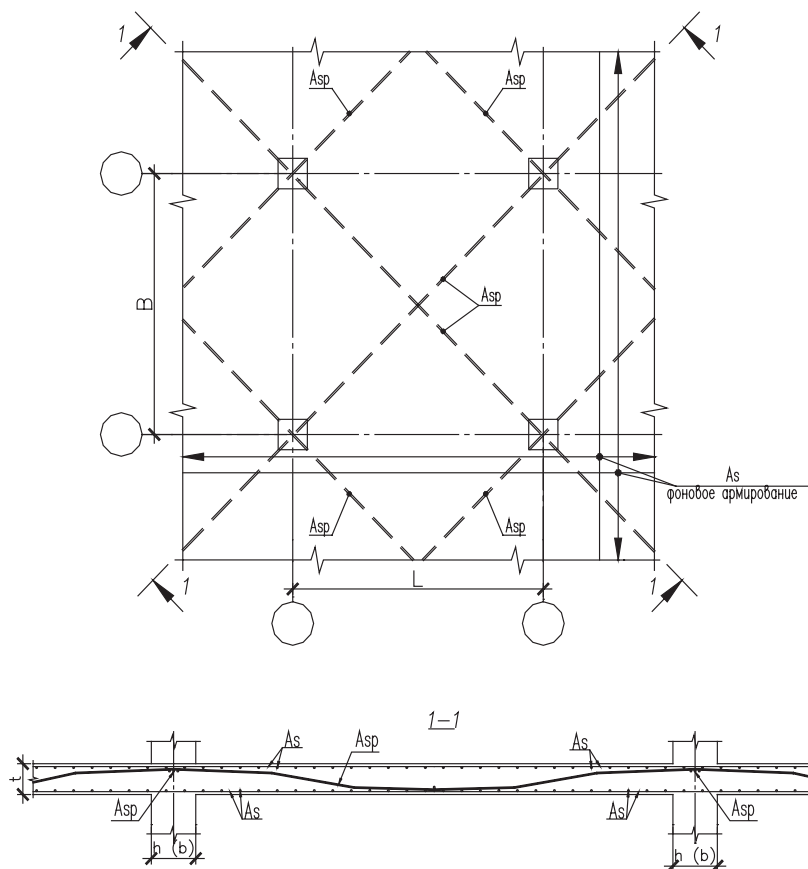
Армирование предварительно напряженной арматурой всего перекрытия
